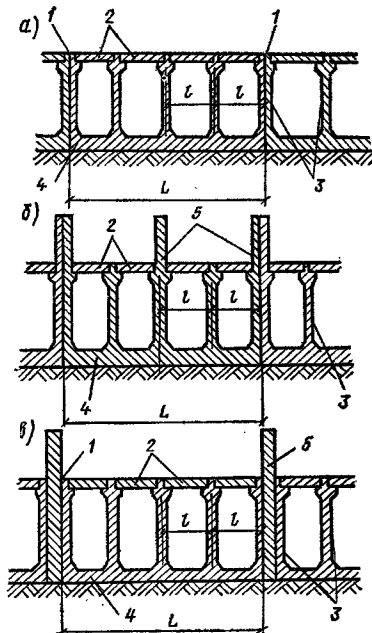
Схемы расположения осадочно-температурных швов контрфорсных плит с плоским напорным перекрытием и фундаментной плитой (вертикальные разрезы по продольной оси плитин)
